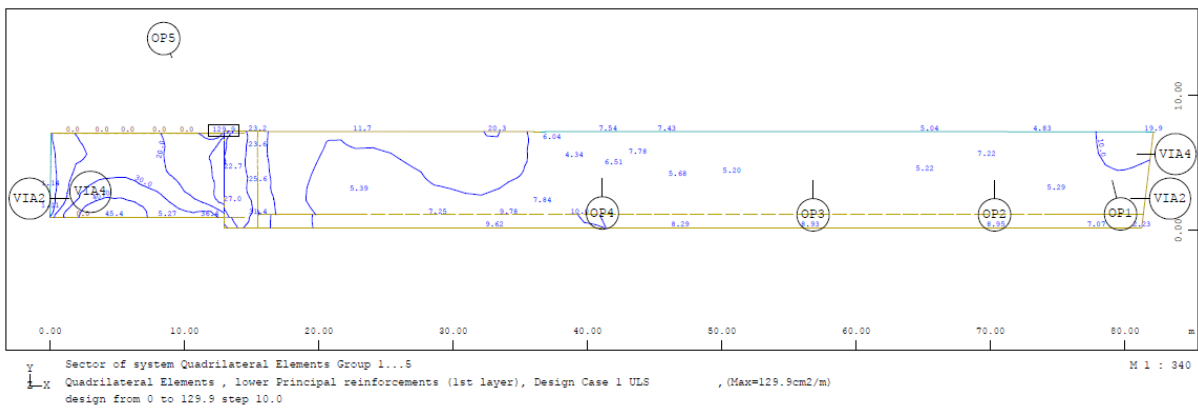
Armado inferior longitudinal de losa en zona de vías.
